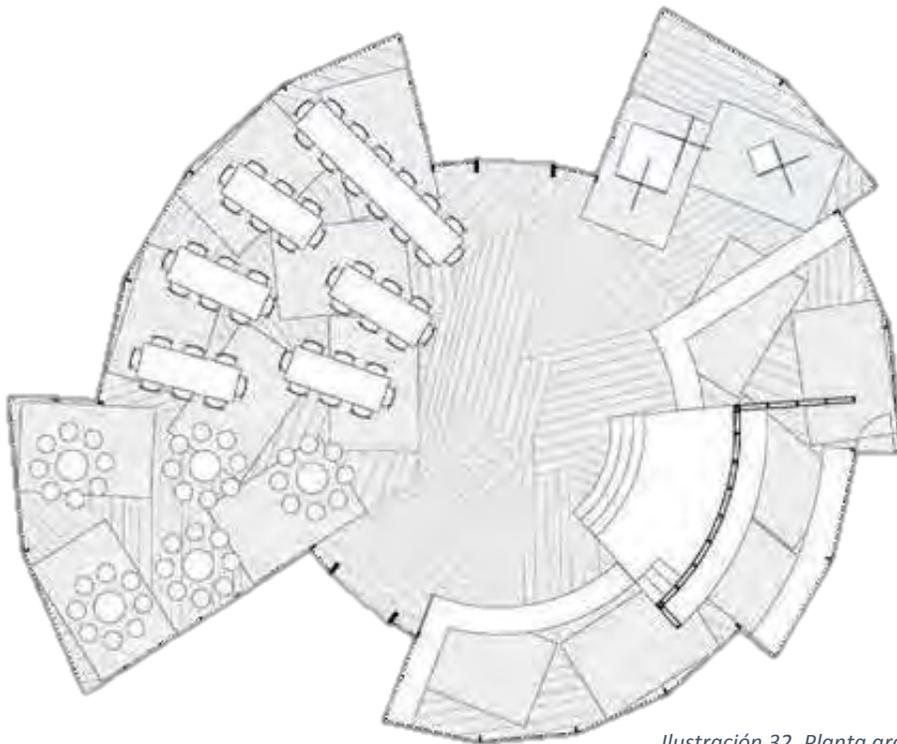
Planta arquitectónica del Meeting Dome. Obtenido de Archdaily.
